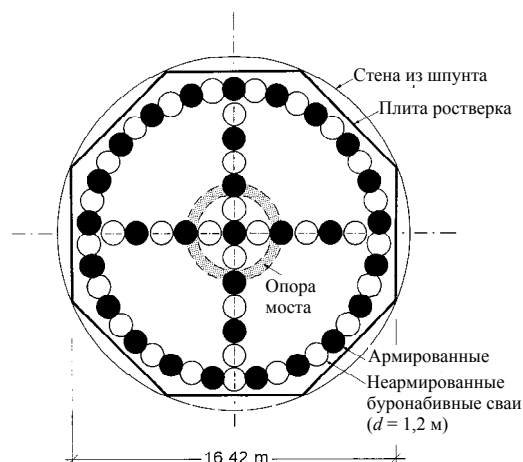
План коробчатого фундамента глубокого заложения для опоры автодорожного моста через реку. Грунт: слабая (заиленная) глина
